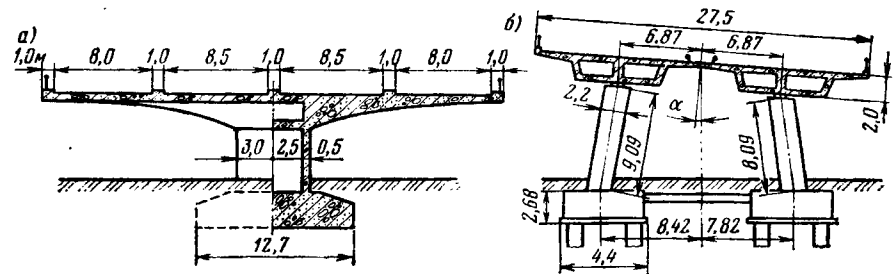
Столчатые опоры, широких железобетонных эстакад
